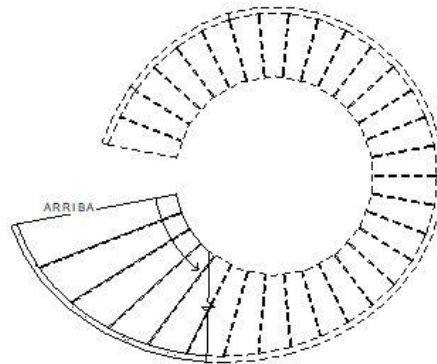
Segundo tramo de la escalera (Vista de planta Nivel 2)
